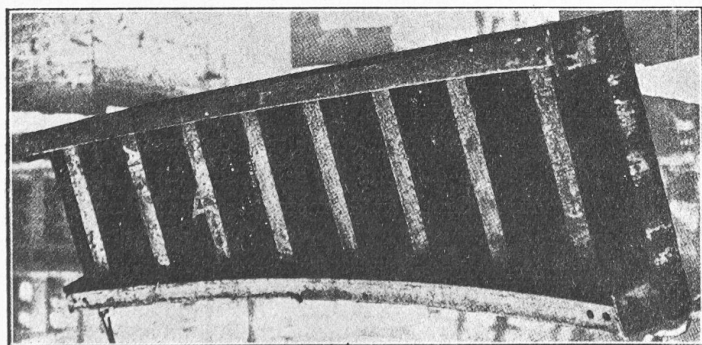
Tunnel à Détroit. — Voussoir en acier laminé.
